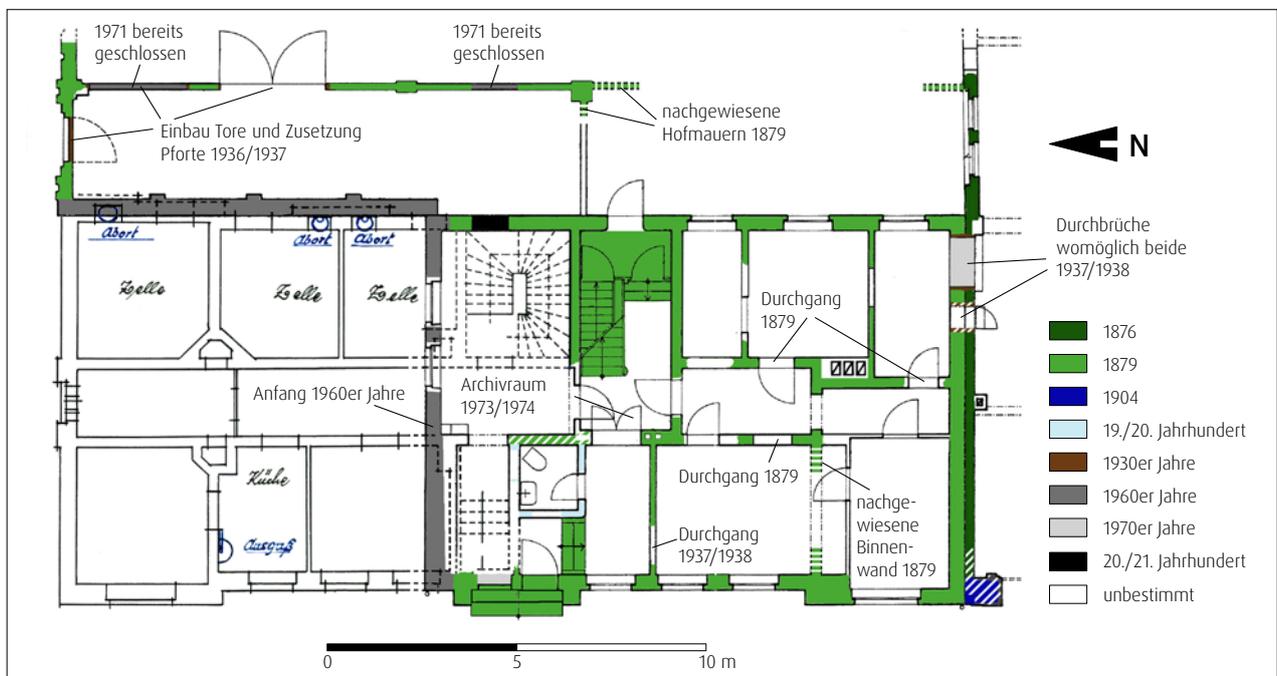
Greifswald, Baderstraße 24. Baualterskartierung für den südlichen Erdgeschossbereich des ehemaligen Polizeigefängnisses und Grundriss des Nordteils nach einer Darstellung von 1914. Zeichnung: D. Brandt (2017). Plangrundlage: Architekturbüro Saalfeld (1995) / Bauamtsakte: Baderstraße 24
